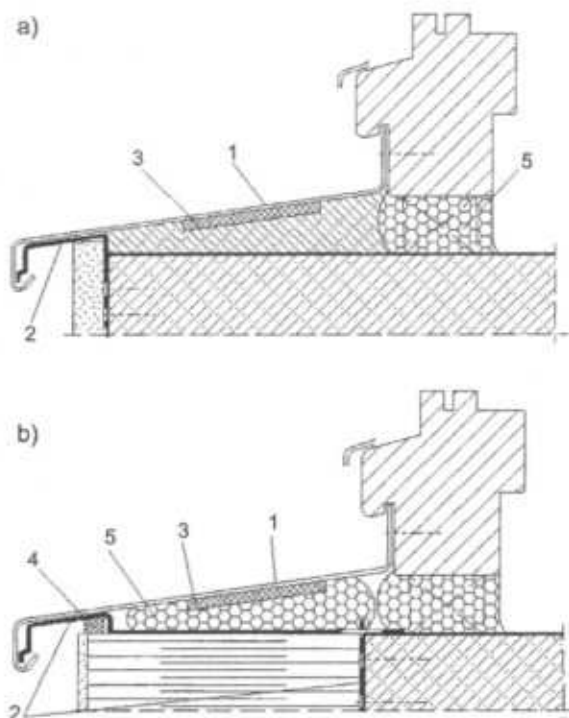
Zamocowanie parapetu zewnętrznego i wewnętrznego do okna z kształtowników PVC
